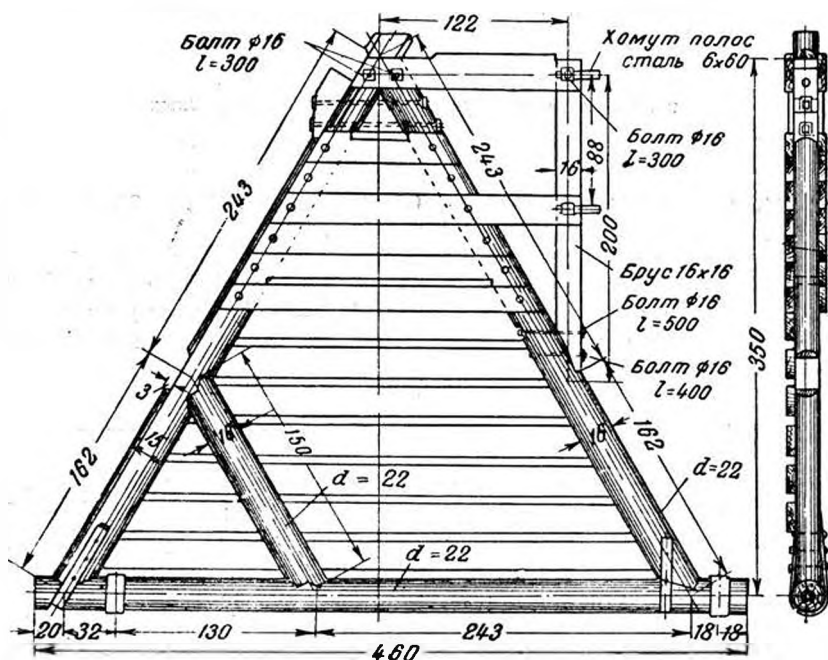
34. Схема флютбета (порога) поворотных ферм
